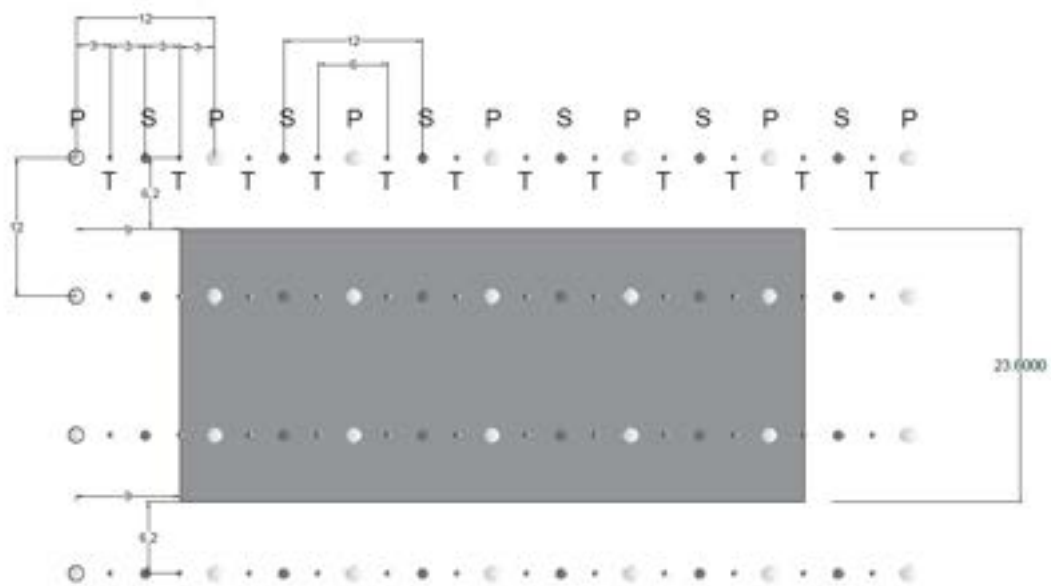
Planta de inyecciones para mejoramiento de roca en fundación de cimacio visto en el cimacio
